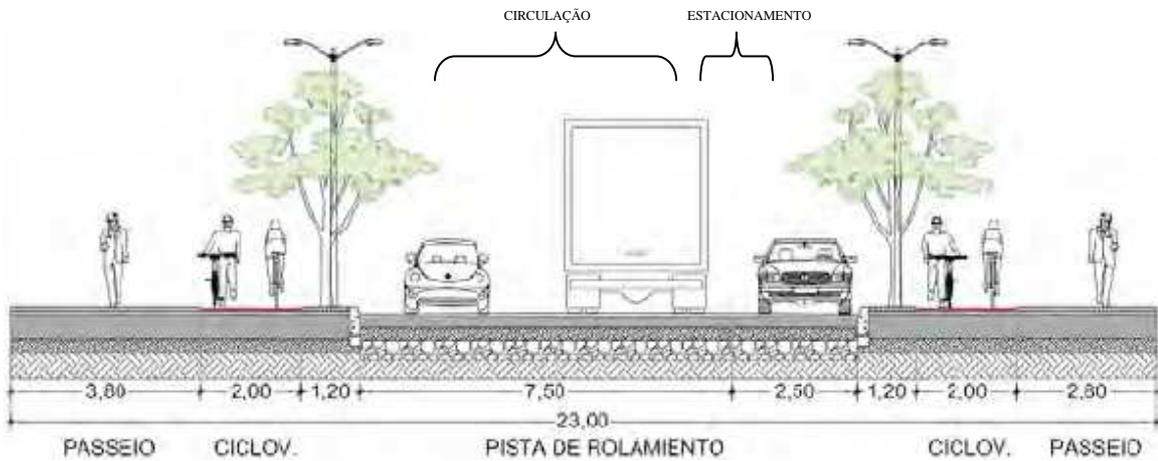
Perfil Proposto para Rua Nossa Senhora da Penha
